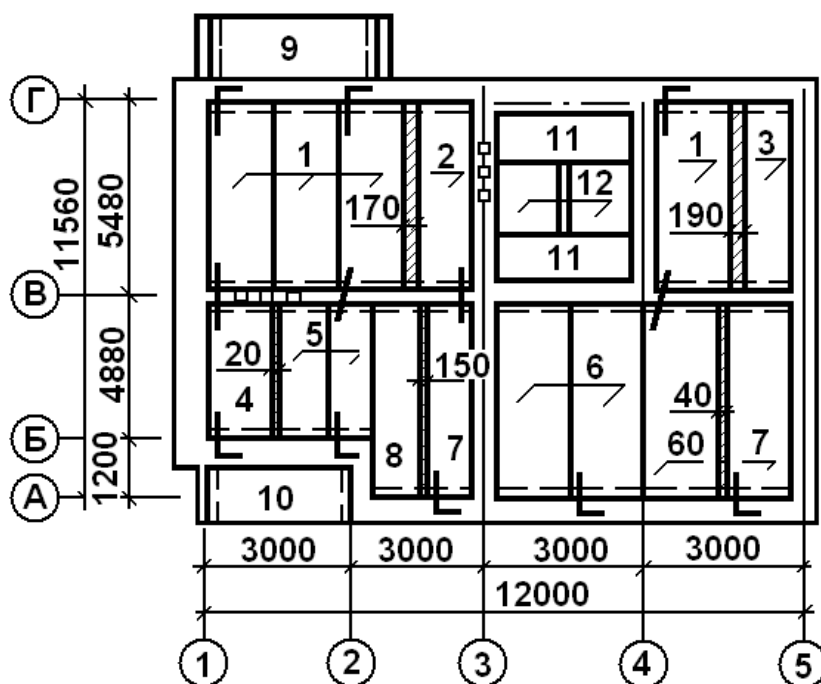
Пример оформления плана перекрытия здания с поперечными несущими стенами
